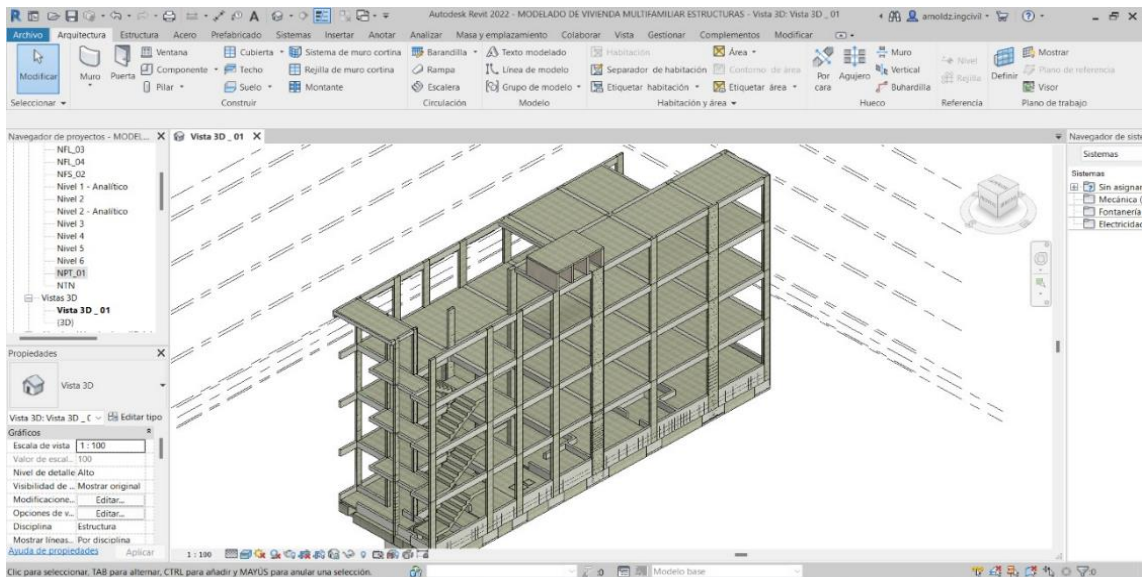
Modelado 3D de Casco Estructural compacto con el modelamiento de acero y concreto – Vista Isométrica.
